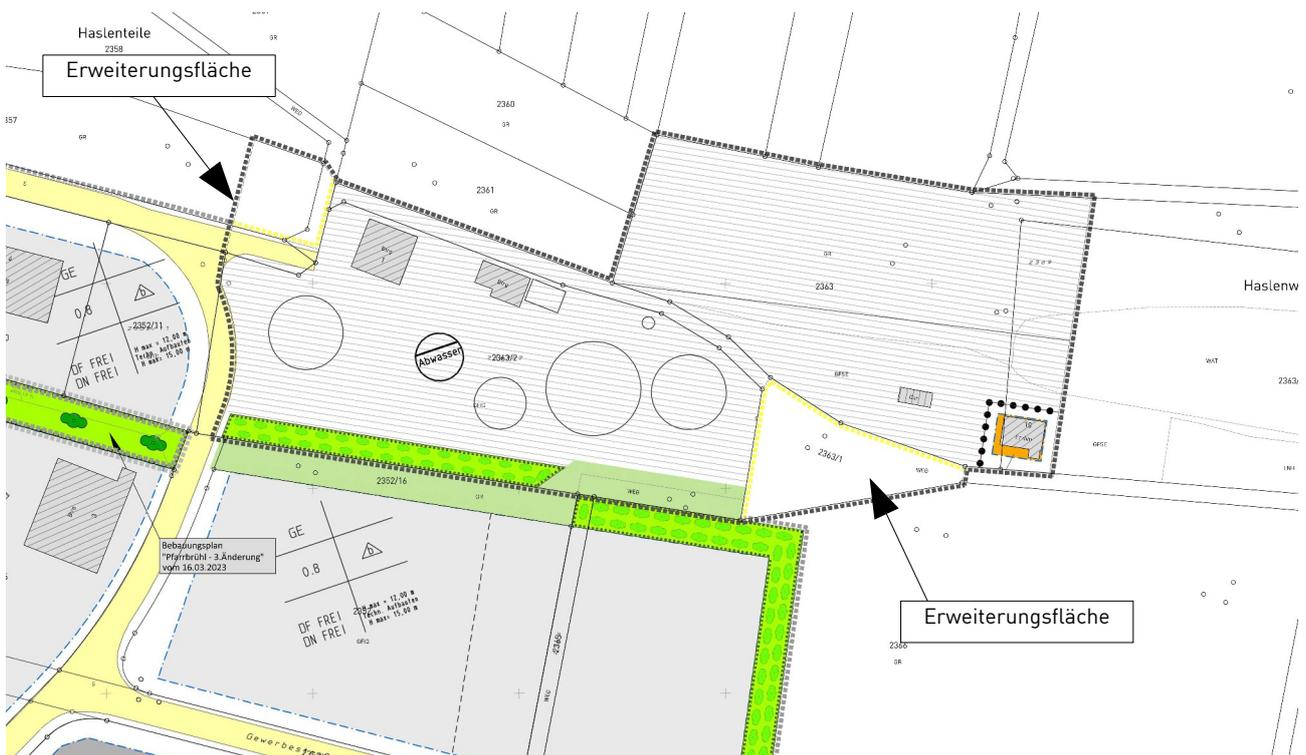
Rechtskräftiger Bebauungsplan „Pfarrbrühl – 2. Änderung“ vom 12.02.2004 mit Darstellung der geplanten Erweiterungsfleichen
